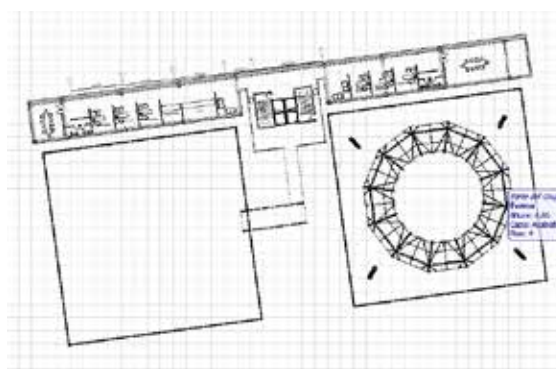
Planta 1 Nivel + 5.50 - Modulo 1. (2016)
